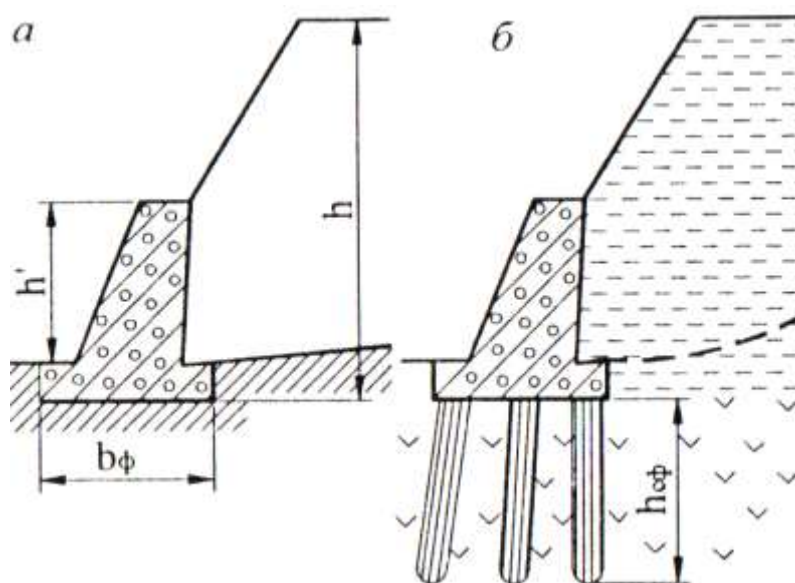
Схема подпорной стенки на скальном основании (а) и свайном фундаменте (б): h и h' – высота уступа и стенки соответственно; b_{ϕ} – ширина фундамента; $h_{сф}$ – глубина свай фундамента
